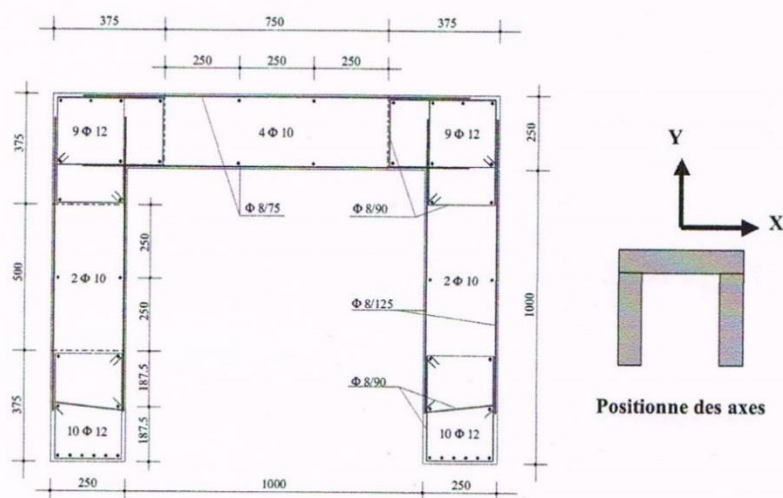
Schéma type du ferrailage des voiles testés au mur de réaction
